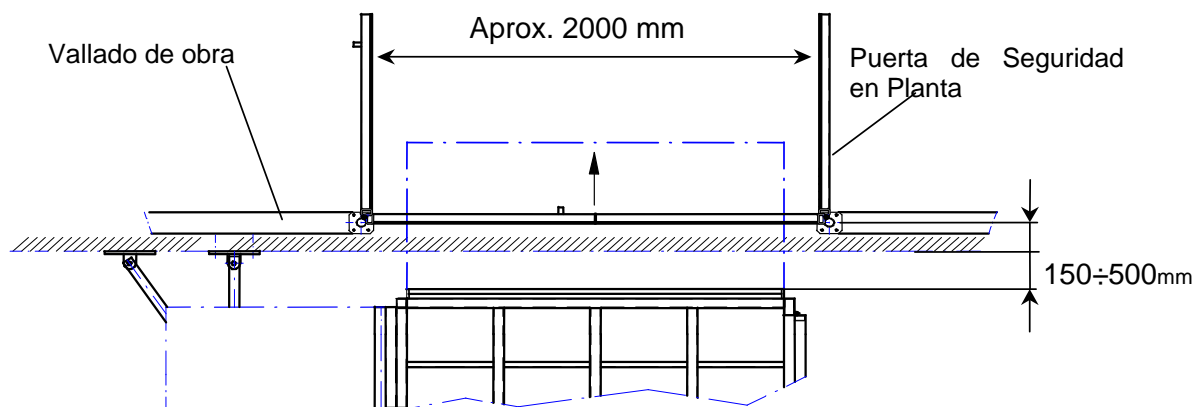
Montaje Puertas Seguridad en Planta (vista en Planta)
